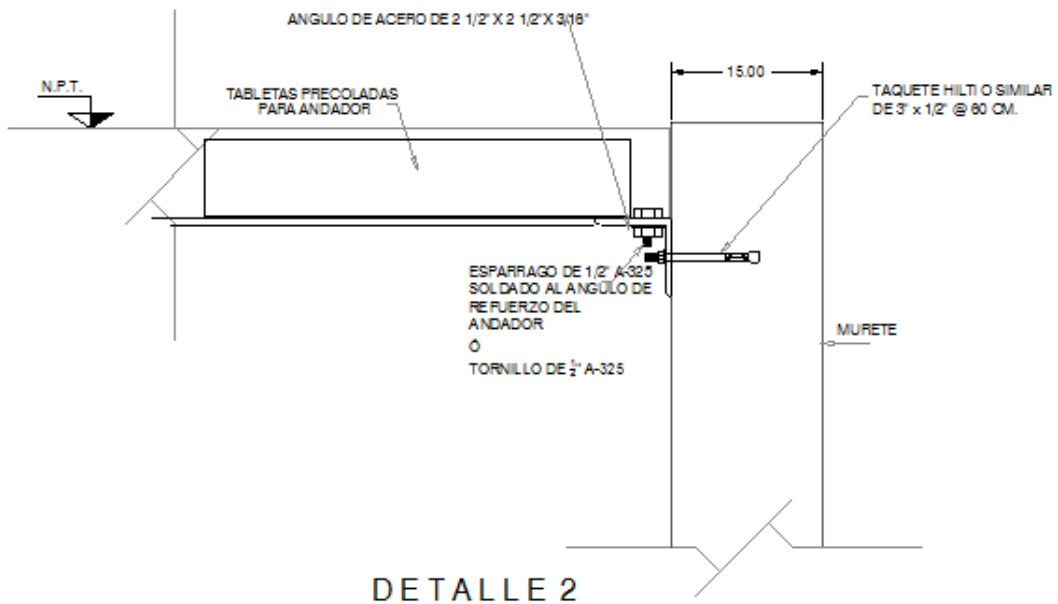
Detalle fijación de soporte para tabletas de policoncreto con murete
